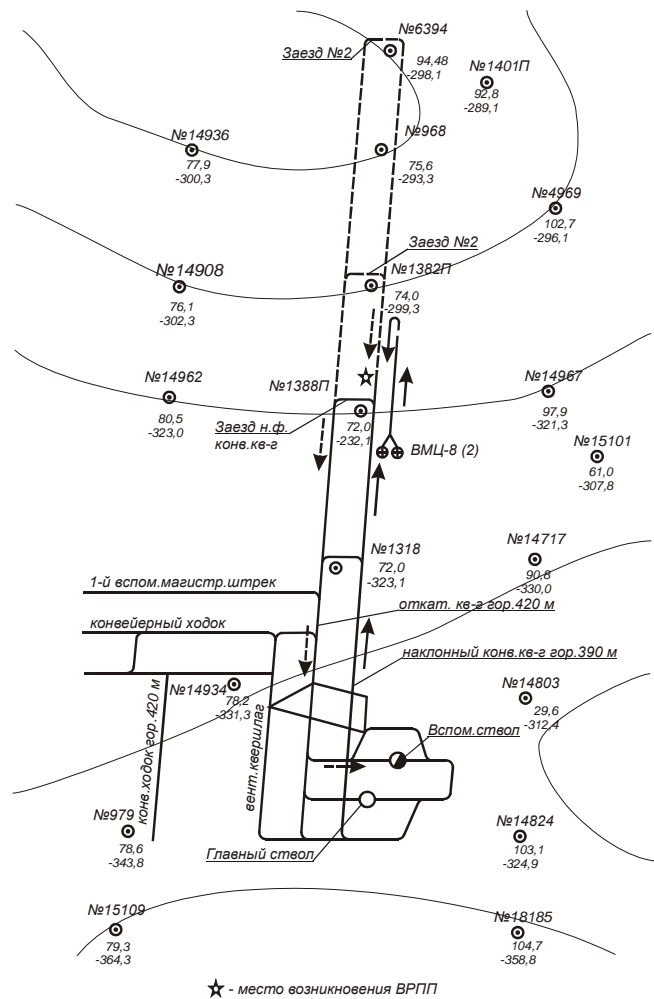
Выкопировка с плана горных выработок пласта c_8^H
